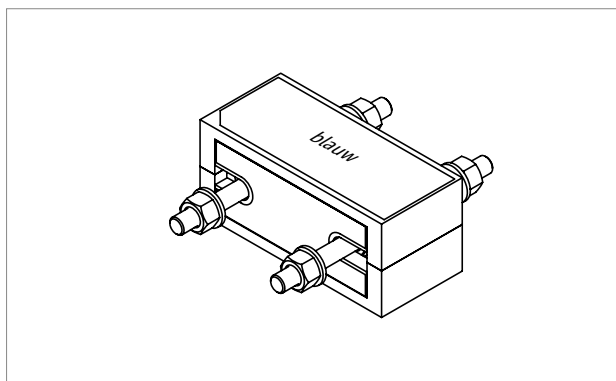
Schöck Isokorb® T type S-V-D22: Doorsnede
